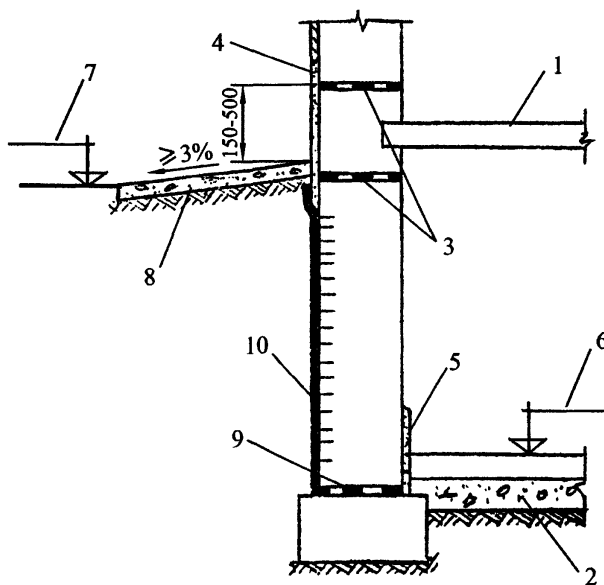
Устройство прокладок в стенах зданий с подвалом при низко расположенном перекрытии подвала
